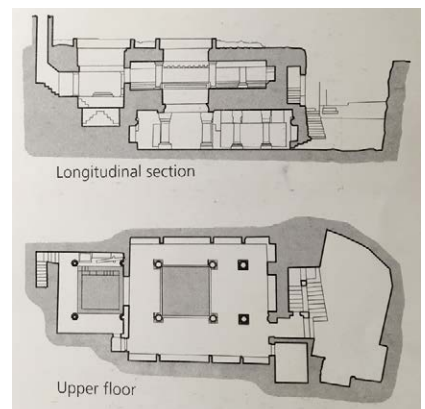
Cueva de Junagarh. Junagarh, Gujarat. Planta y sección.
